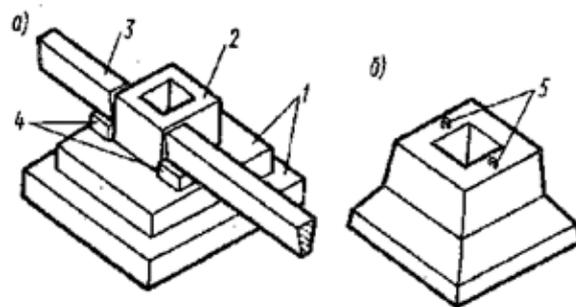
Сборный фундамент под колонну: а – из нескольких элементов; б – из одного элемента; 1 – фундаментные плиты; 2 – подколонник; 3 – рандбалка; 4 – бетонные столбики; 5 – монтажные петли
